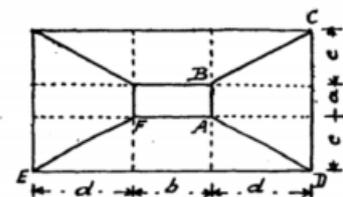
División zapata para el cálculo de momentos flectores y cortantes (Fernández, 1936a)
